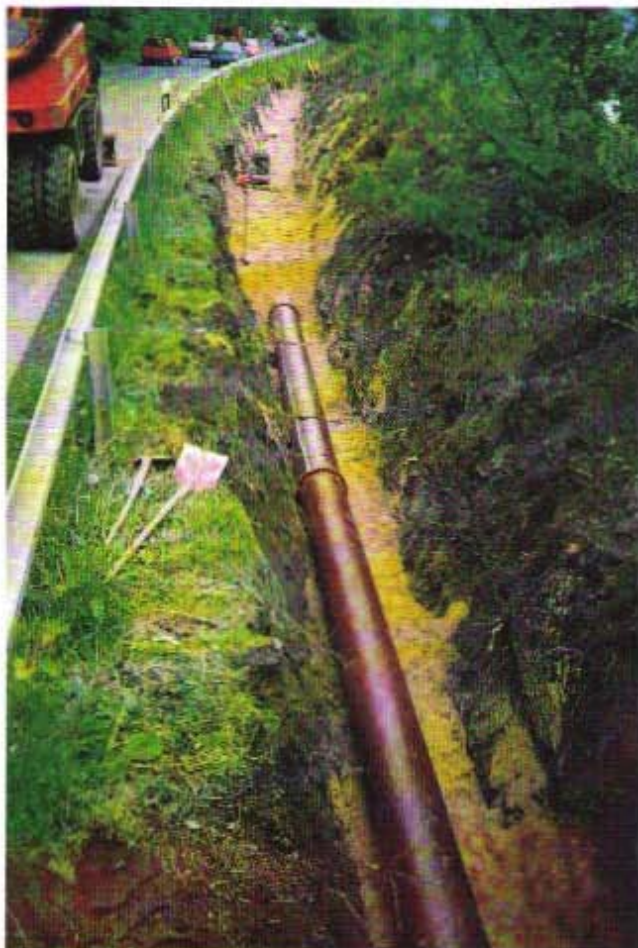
Straßenquerung, Rohrdurchführung im Schutzrohr
